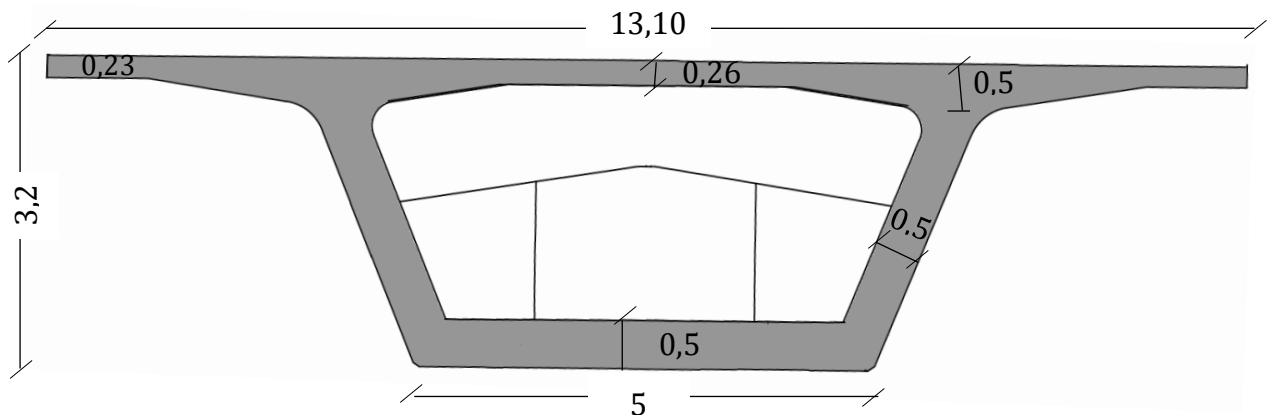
Coupe transversal (coupe 03) du voussoir sur tête-pile (VSP)
